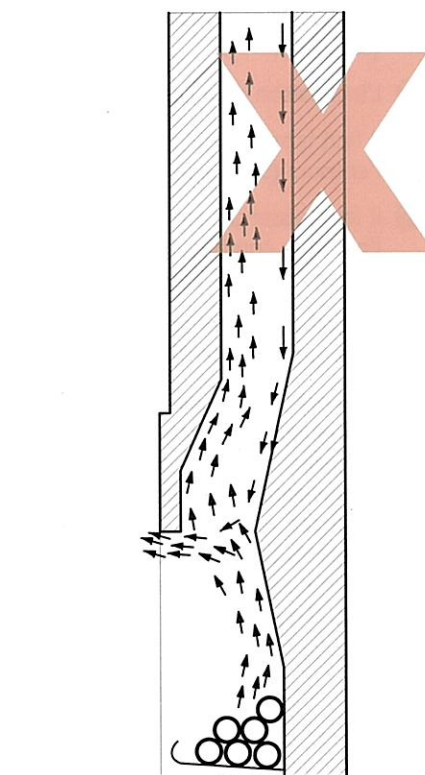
Normes de construction des foyers traditionnels en maçonnerie (suite)
